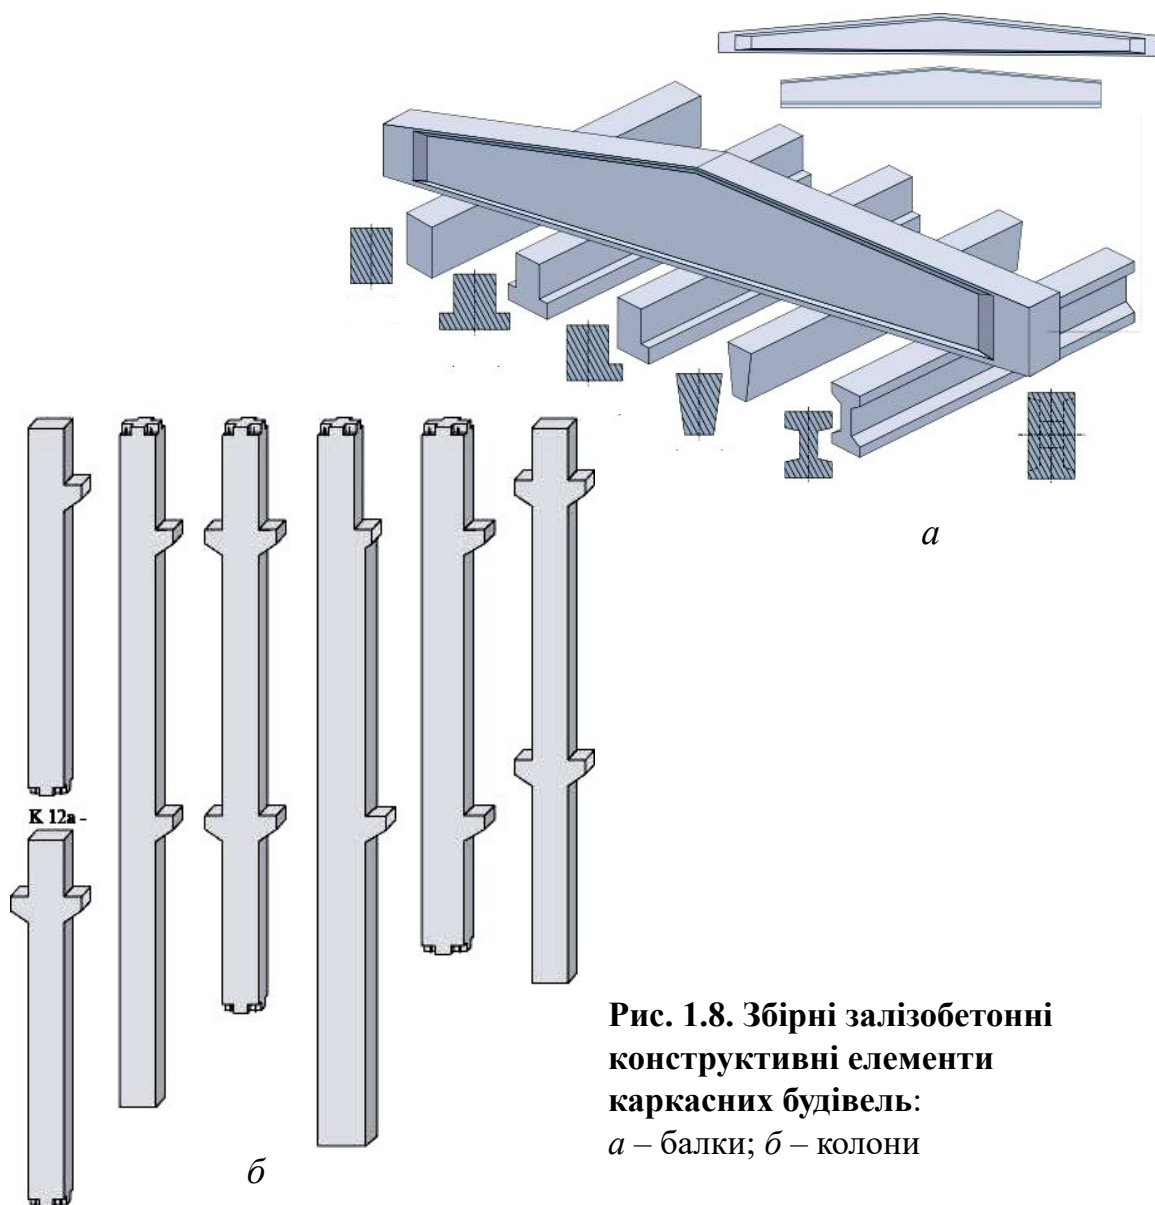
Збірні залізобетонні конструктивні елементи каркасних будівель:
